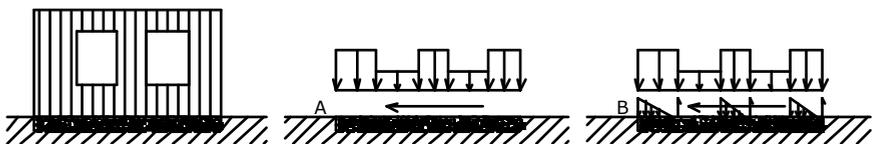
Sollecitazioni sulle fondazioni. A - La schematizzazione non è corretta. B - Schematizzazione corretta ma estremamente complessa da descrivere. In questo caso è possibile che la struttura in elevazione e la fondazione la progettino figure diverse, tuttavia è estremamente difficile trasferire fra i due Tecnici le informazioni corrette.
